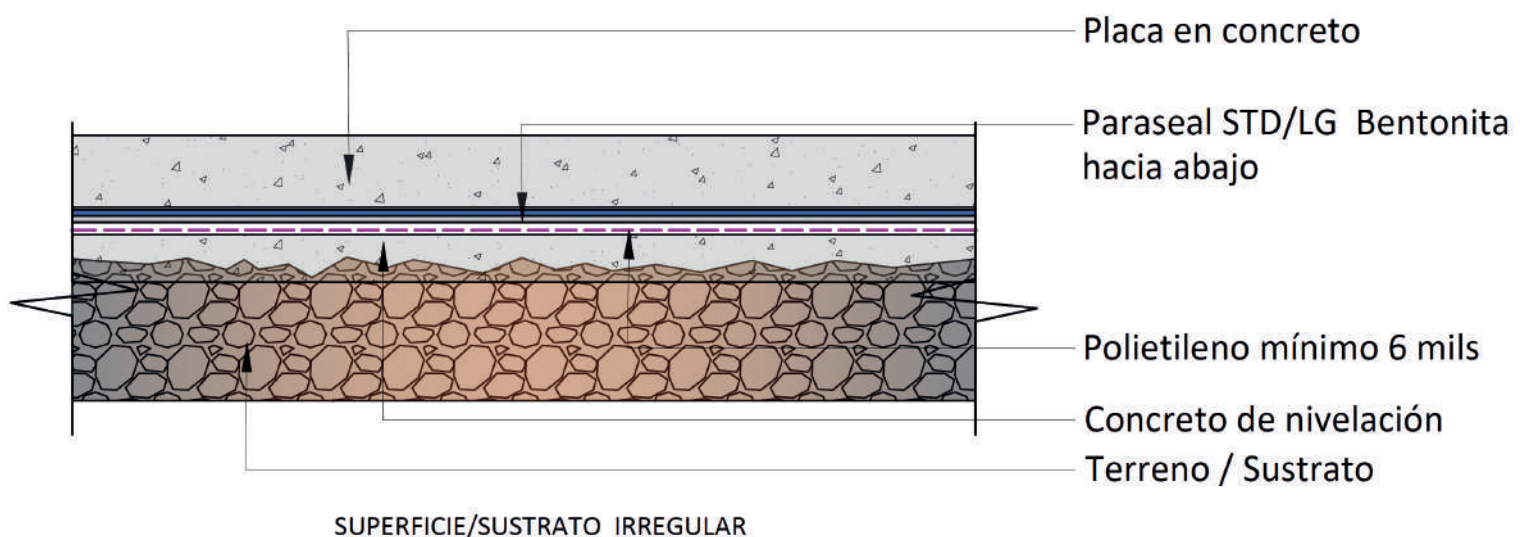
Detalle PARASEAL STD/LG sobre una subbase.
